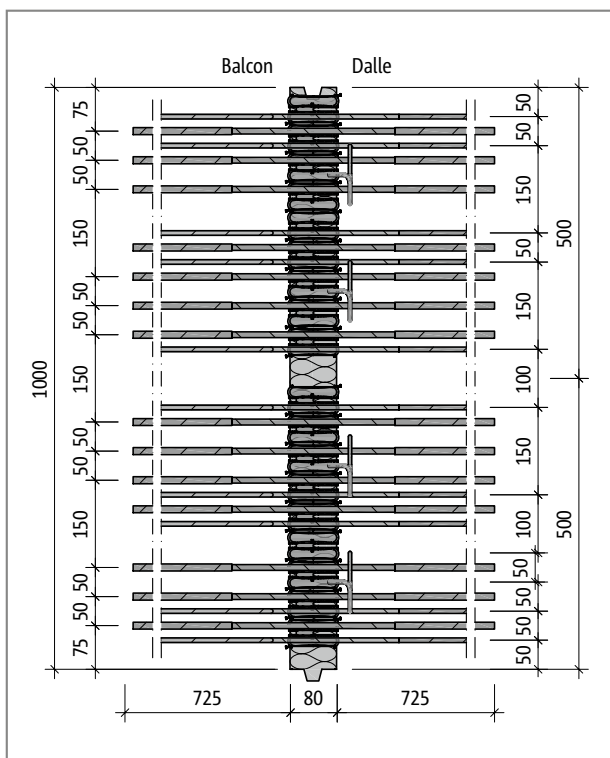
Schöck Isokorb® T Type K-T-M10-V1 : Plan de base du produit
